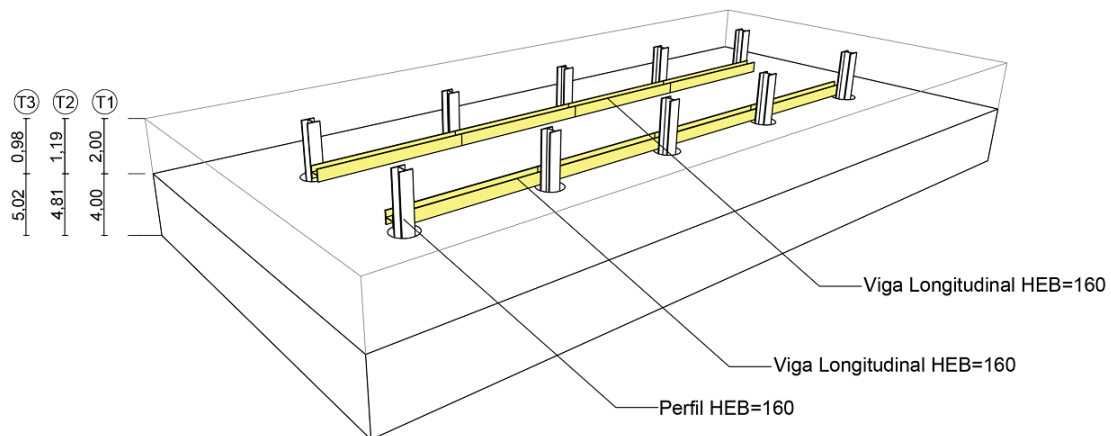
D2 Proceso suelda vigas longitudinales en sección de tramo 1-2-3
